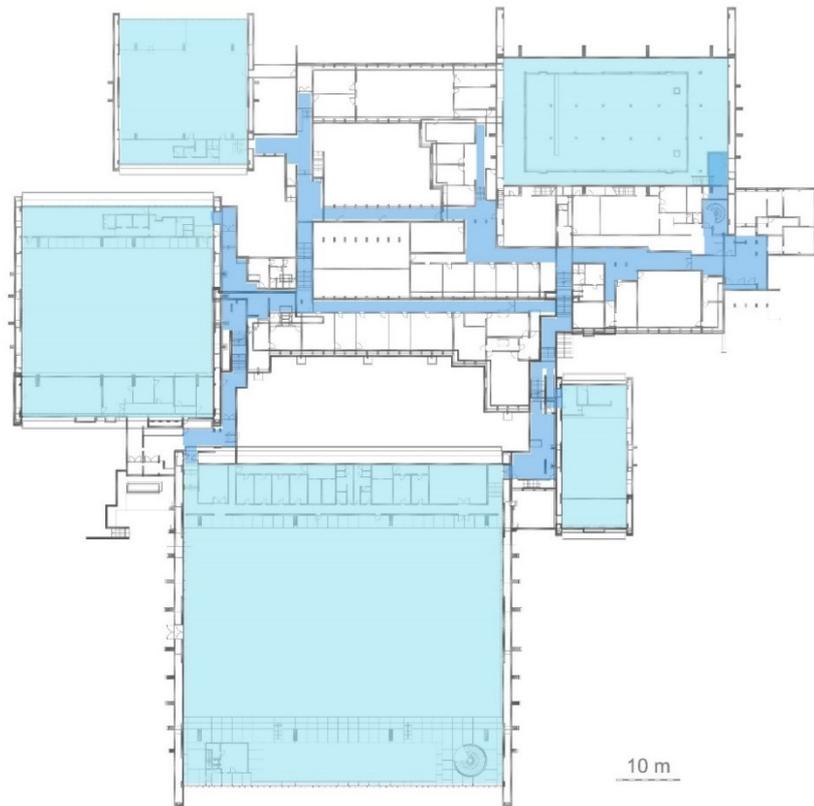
La déambulation dans l'institut. Plans -2, -1, rez, +1 superposés. Plans reçus par ©S. Devyver via ©I'ARI. Retravaillés par ©L. Loix.
